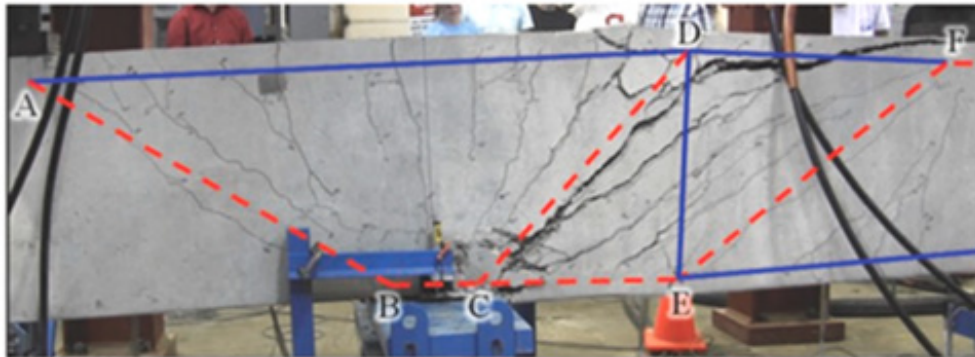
Padrão de fissuração para viga solicitadas por cargas estáticas
